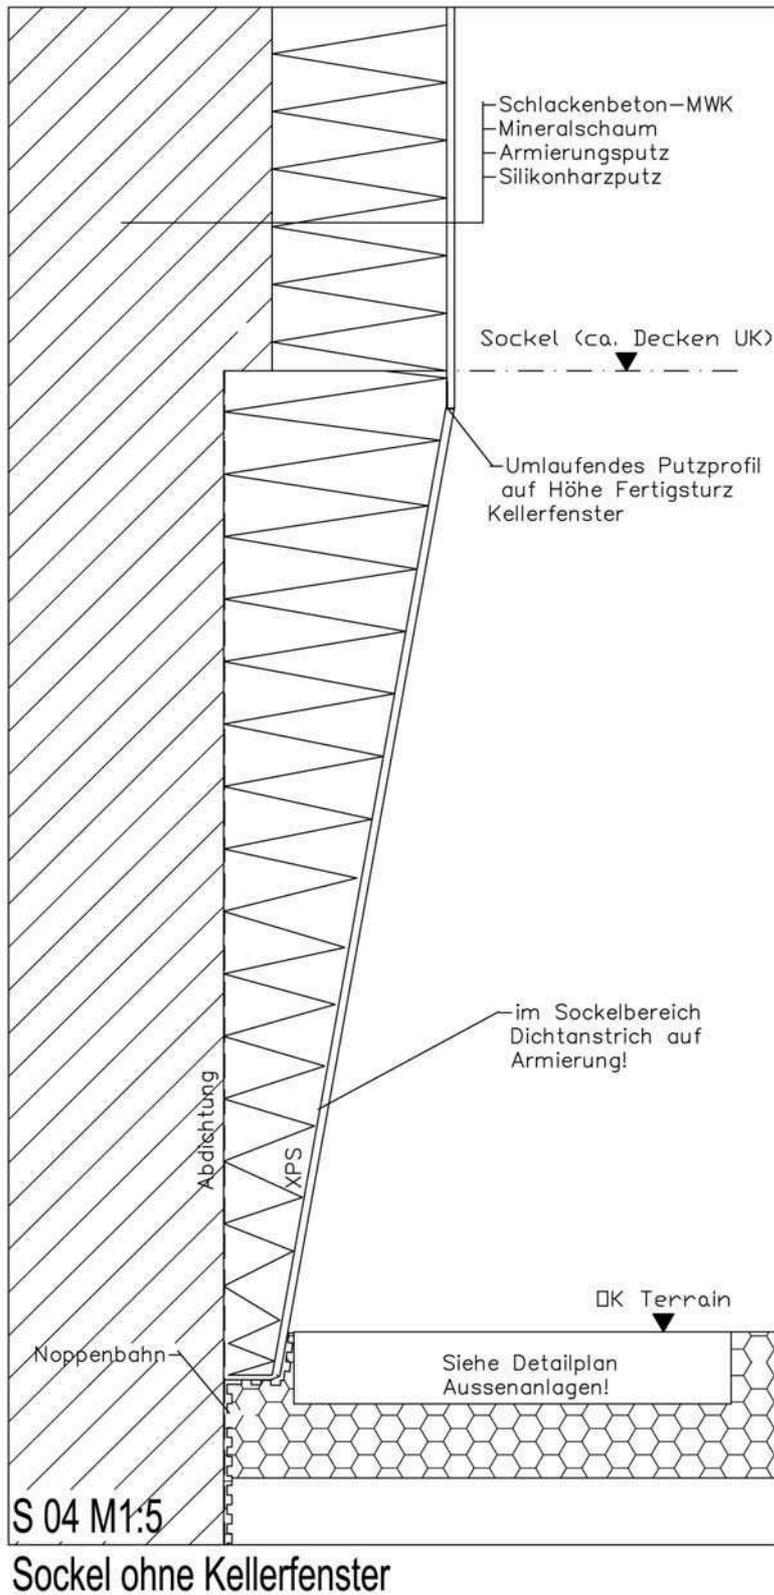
Detail S 04 Sockeldetail Fassadensanierung
